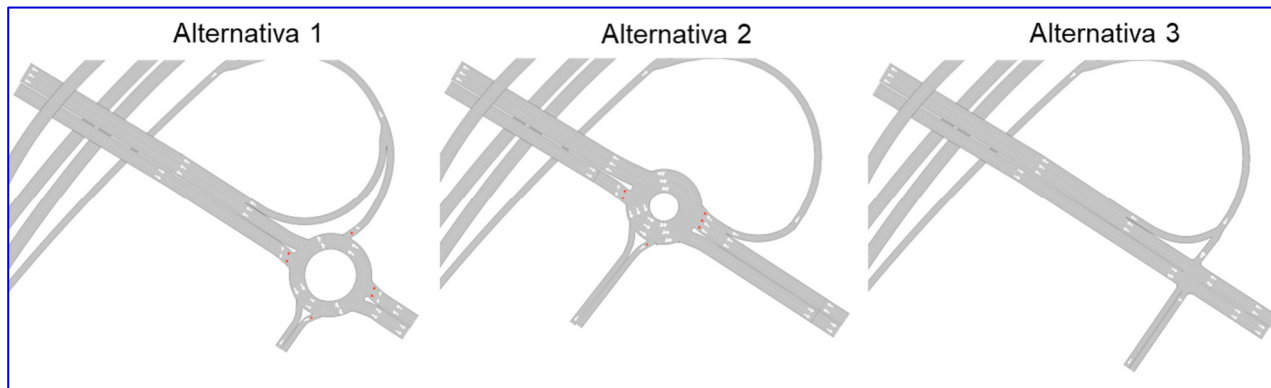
Alternativas constructivas de la calle Monasterio de Arlanza
